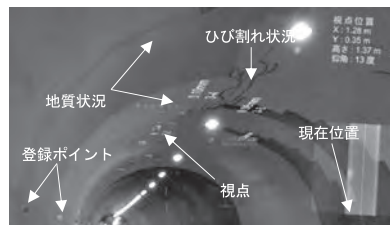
地質及び覆工ひび割れ状況(仮想)表示例
